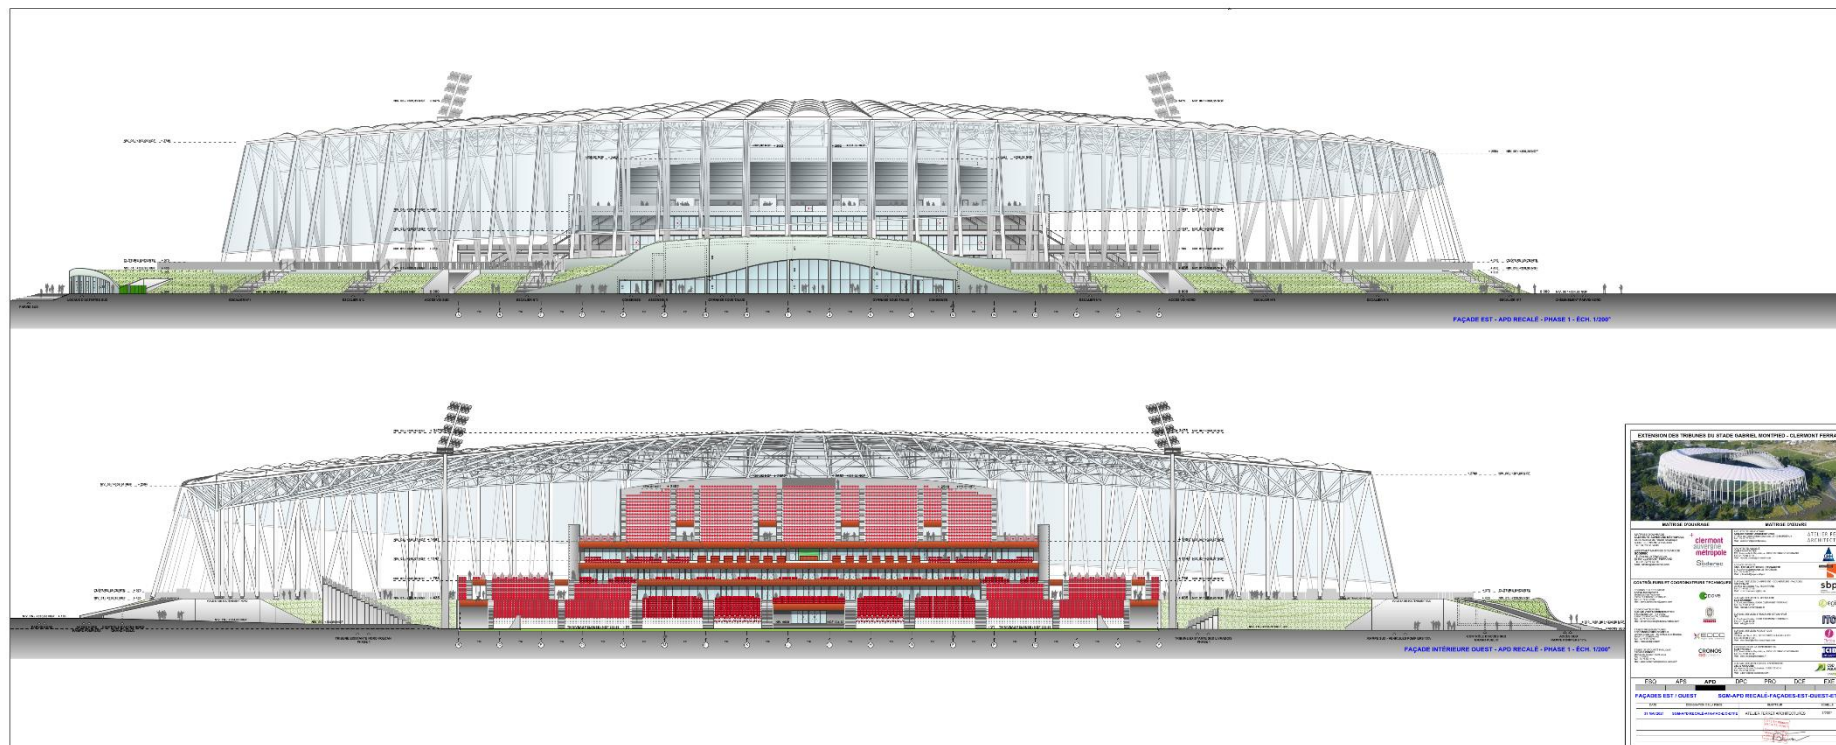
Façade Est en haut, façade intérieur ouest en bas
